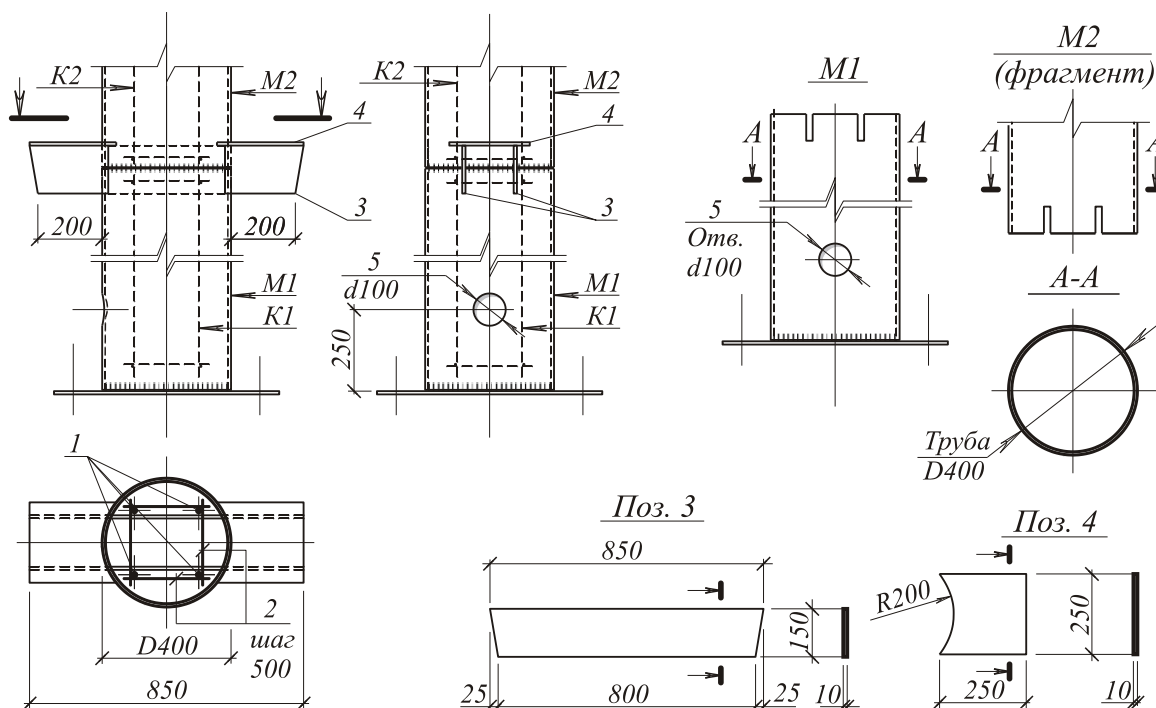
Конструкция узла сопряжения колонны и опорных консолей
